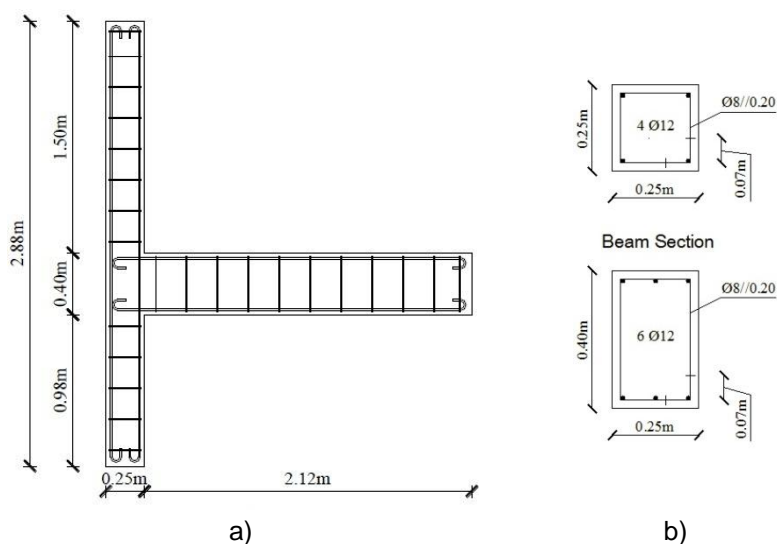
Armadura do provete TPC: a) disposição geral; b) detalhes das secções;
